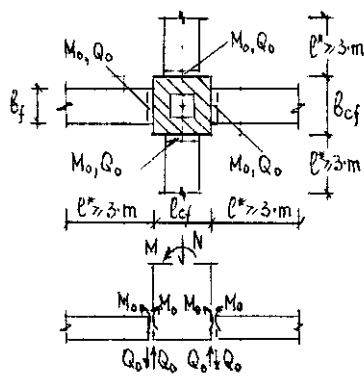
Расчётные схемы для определения полных эпюр отпора грунта q , изгибающих моментов M и поперечных сил Q в ленточных фундаментах под ряды колонн
